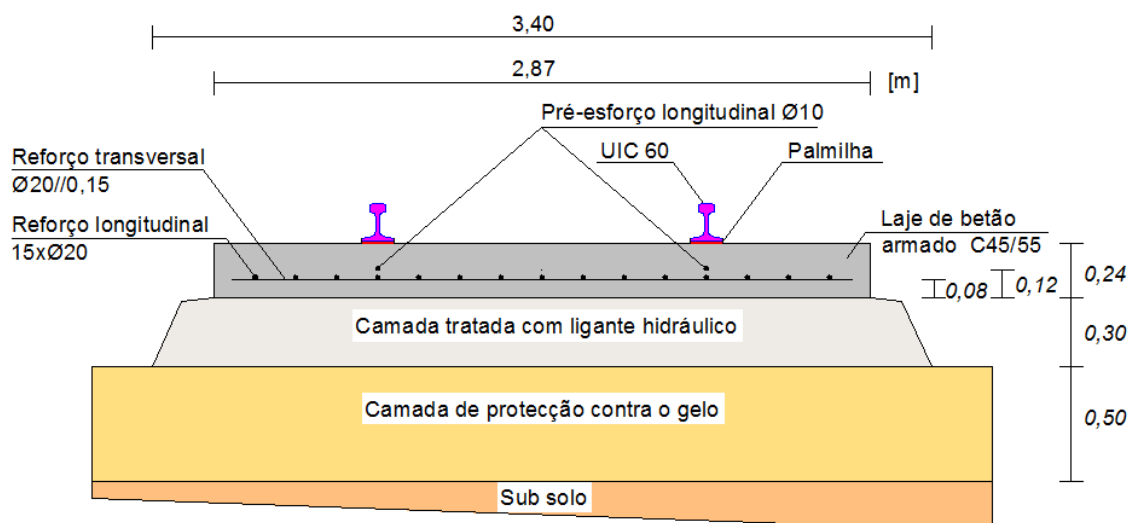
Perfil transversal esquemático da via em laje com armadura ordinária inferior e pré-esforço longitudinal (Marques, J. 2013)
